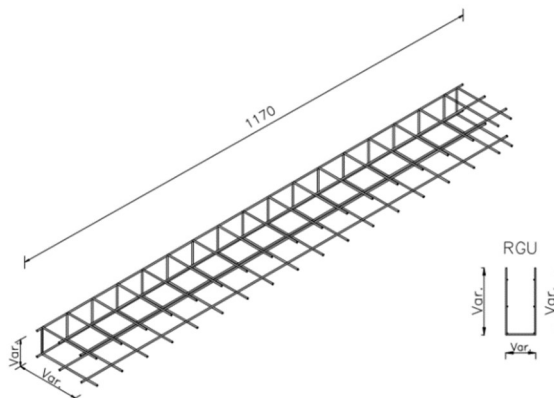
Malla de refuerzo tipo RU - Emmedue, 2008.
